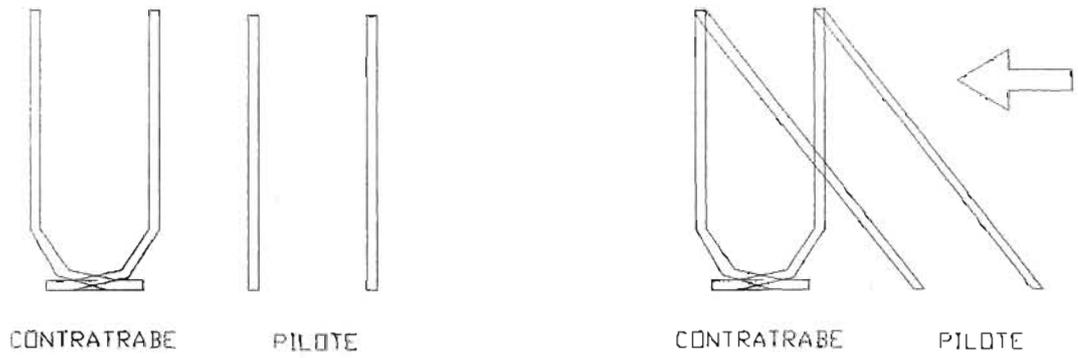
Amarre de contratrabe con pilote desfasado.
